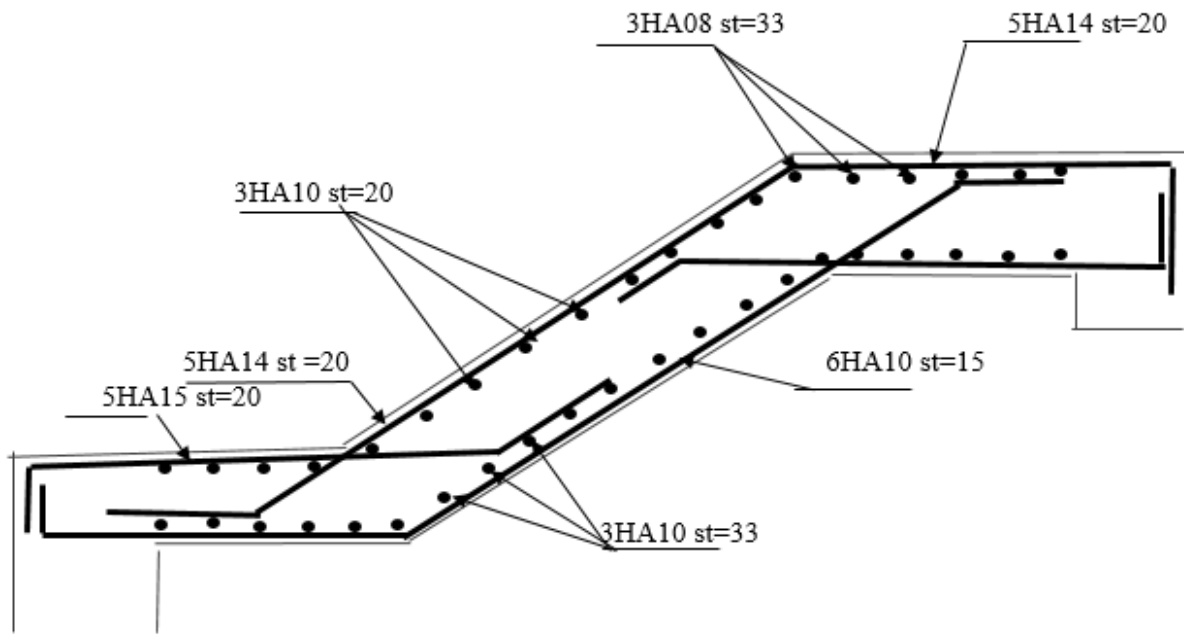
Schéma de ferrailage d'escaliers type 02'
